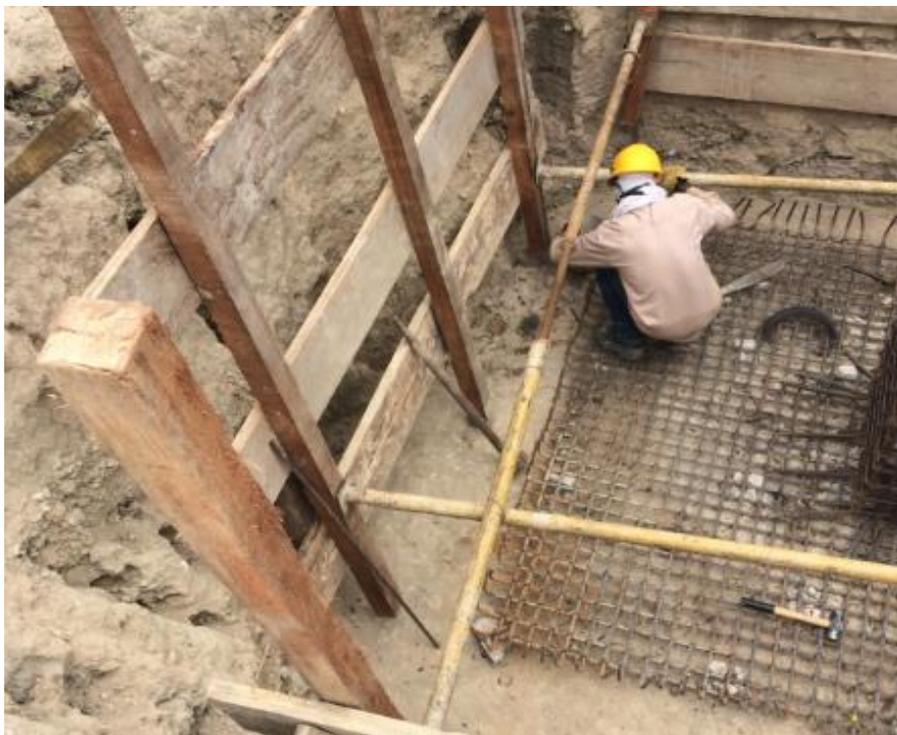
Entibado para excavación, fijación de parales, consolidación del sistema.
